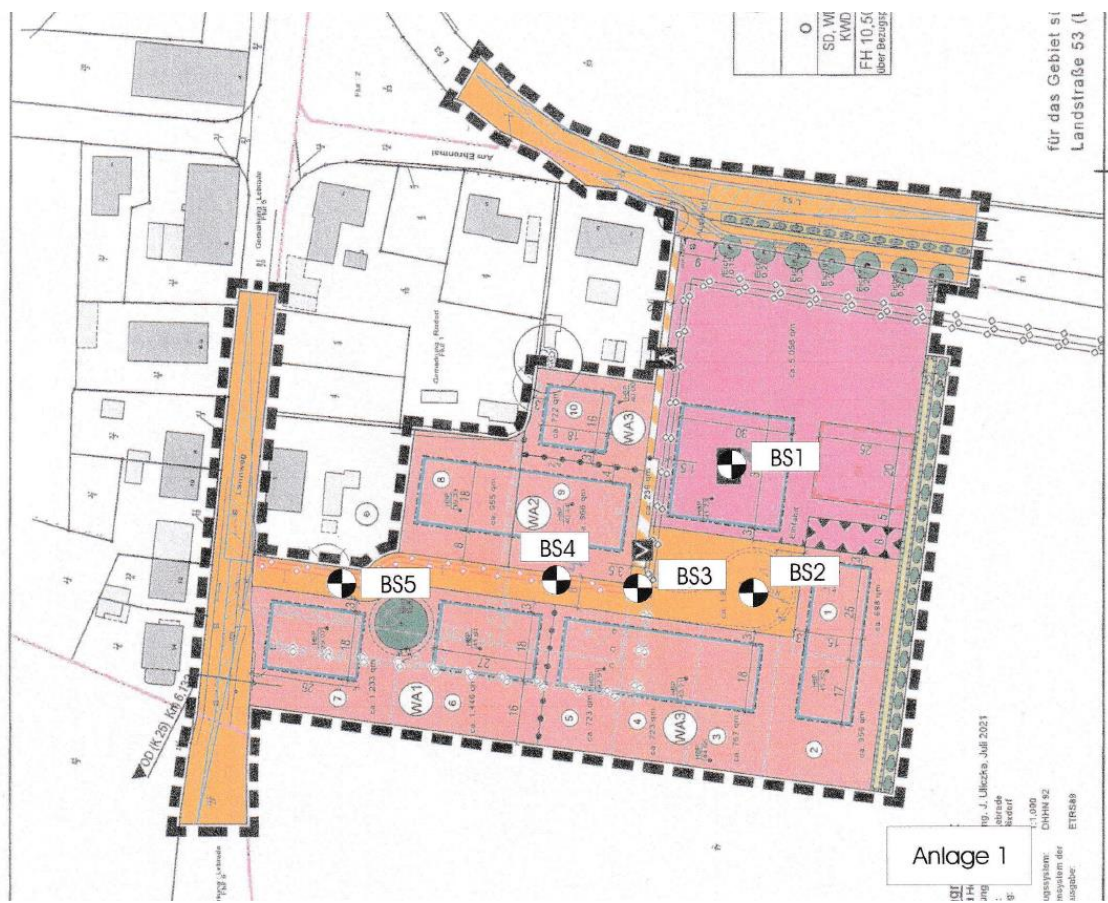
Lageplan der Rammkernsondierungen (Quelle: Ergebnisbericht zur Erkundung der Bodenverhältnisse vom 23.09.2021)
